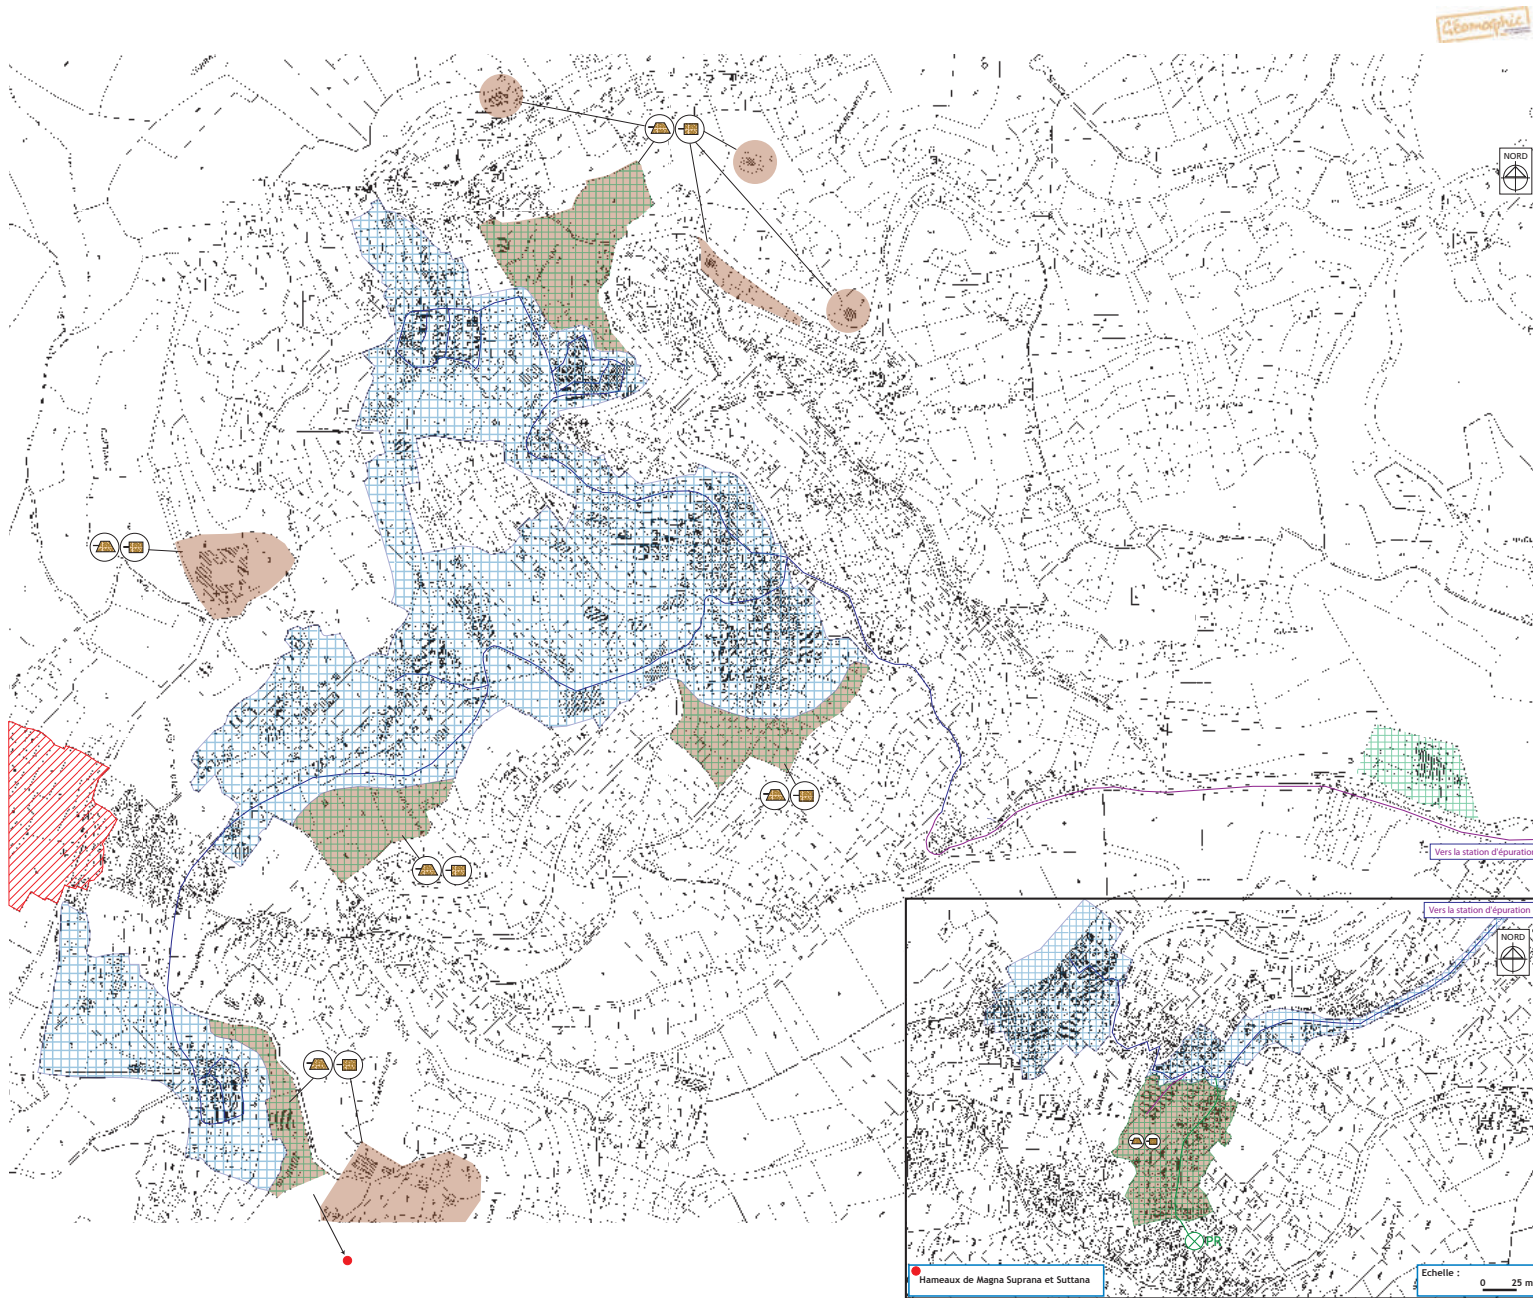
Plan de zonage de l'assainissement - Partie Village
